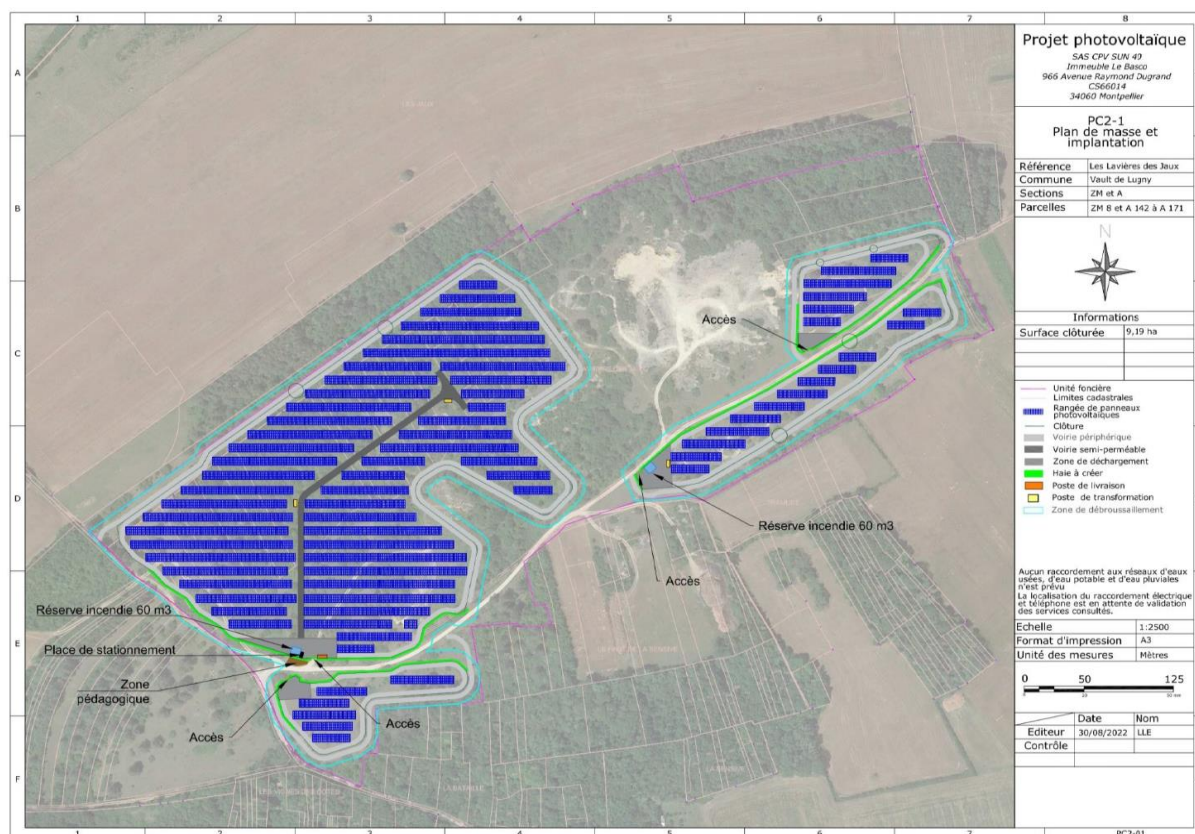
Plan du site avec voiries accessibles par les véhicules de secours et d'intervention
